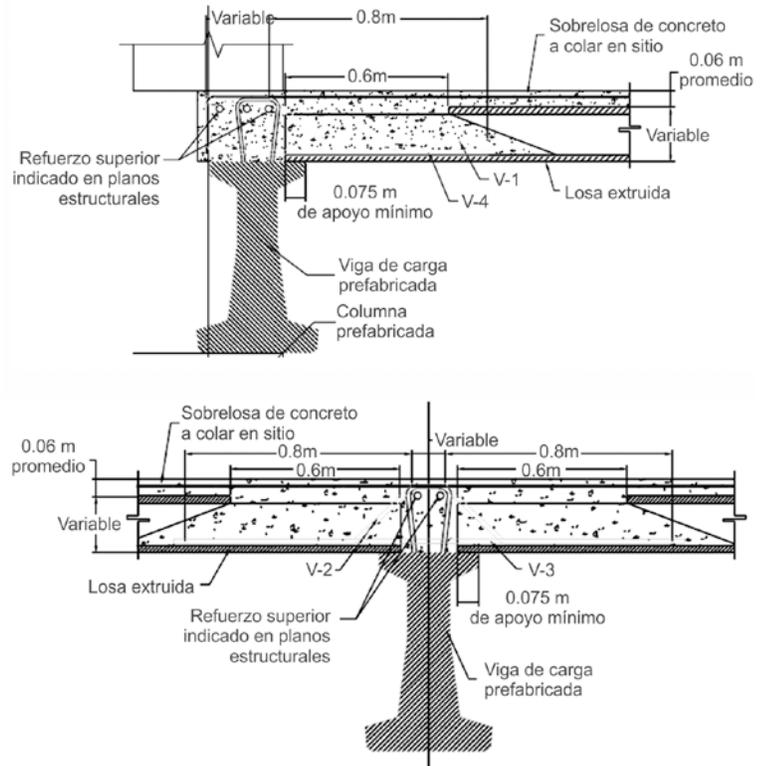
Detalles constructivos de Losa Lex (continuación)
